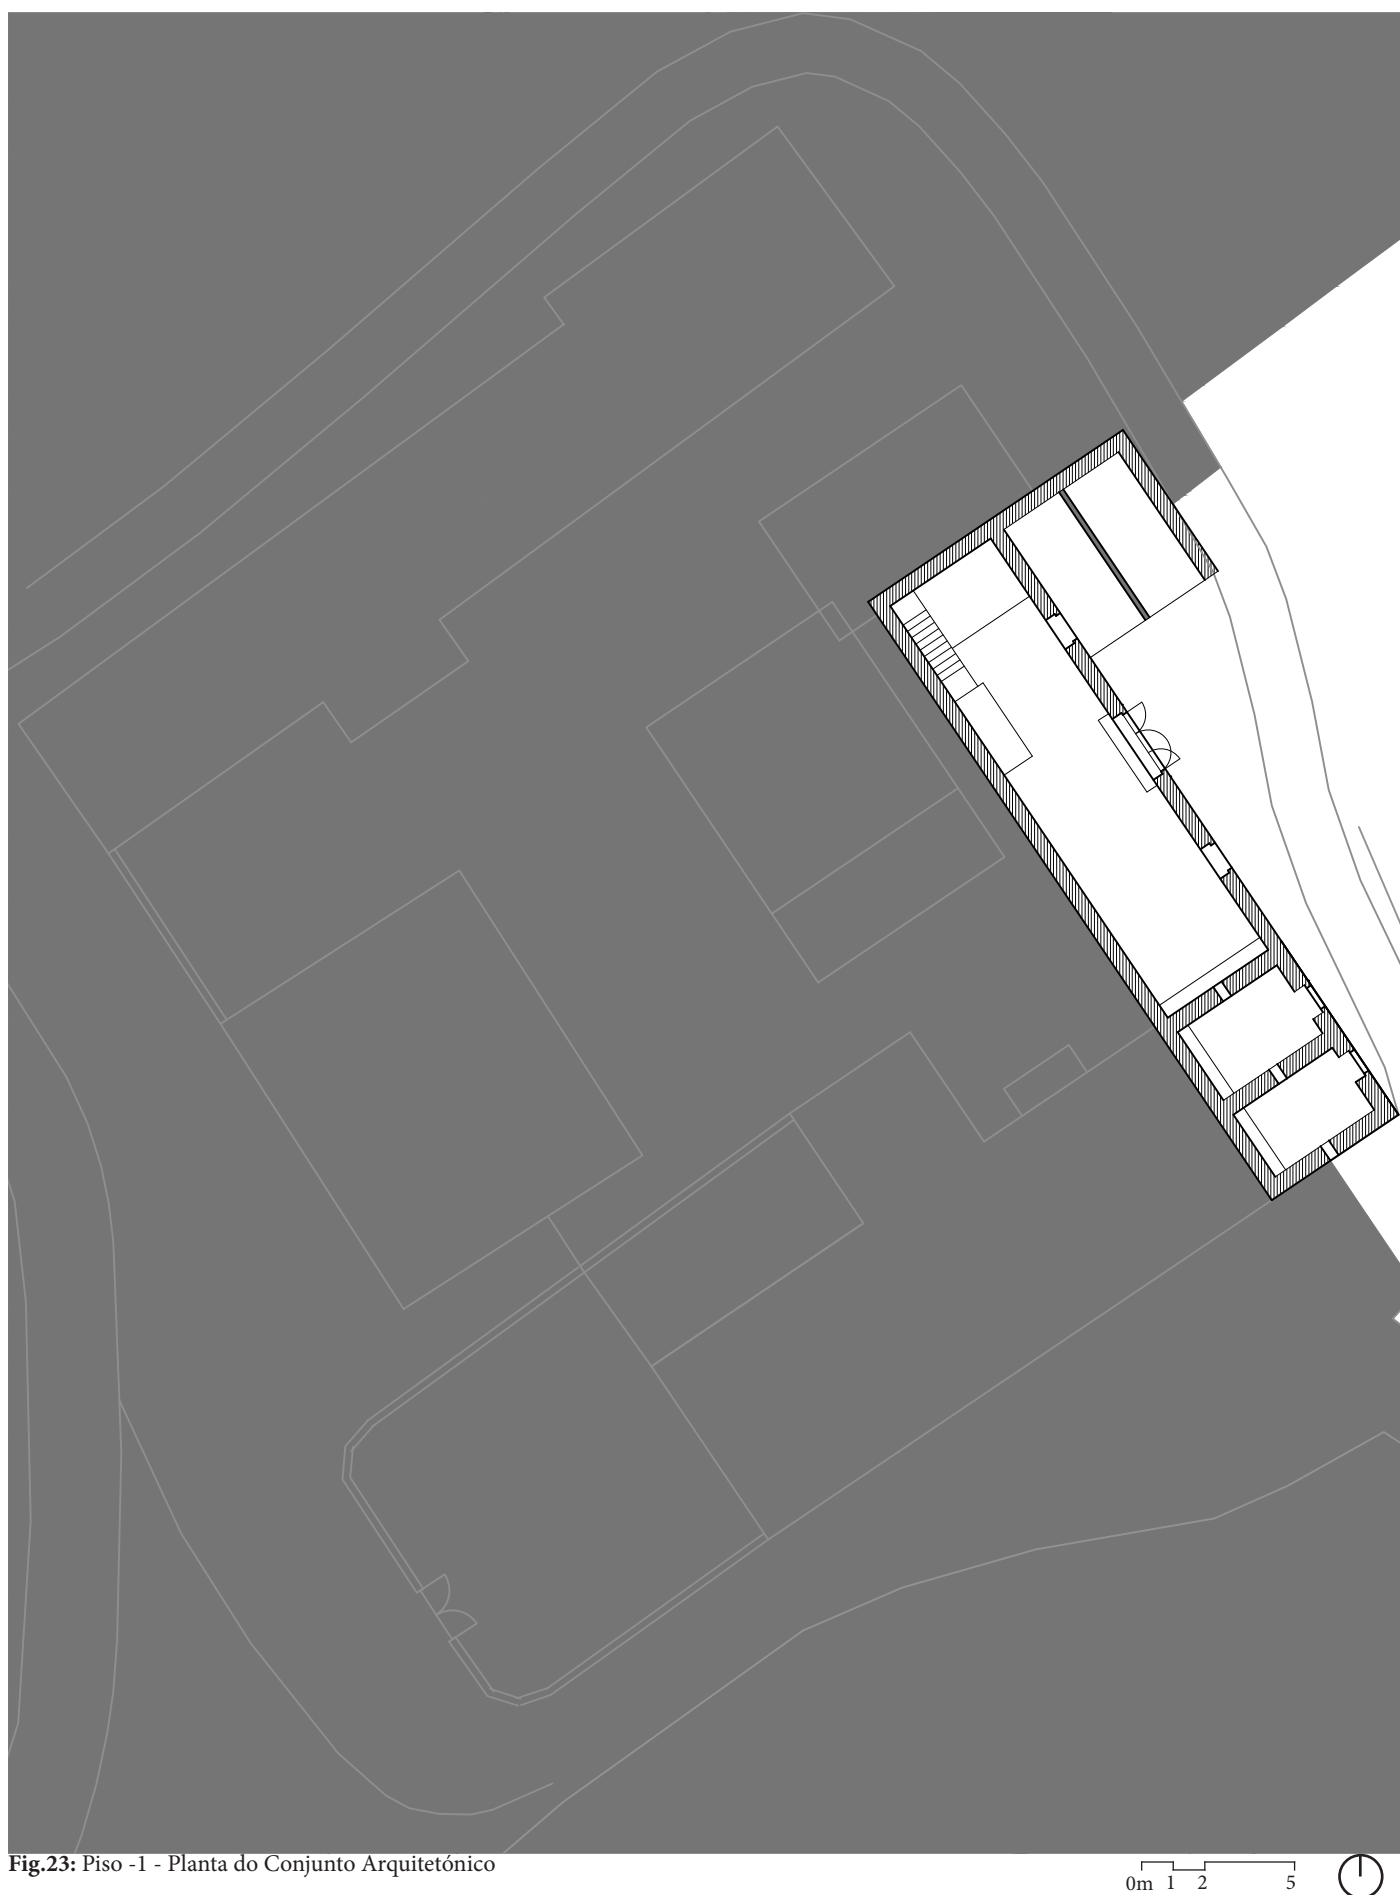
Piso -1 - Planta do Conjunto Arquitetónico
